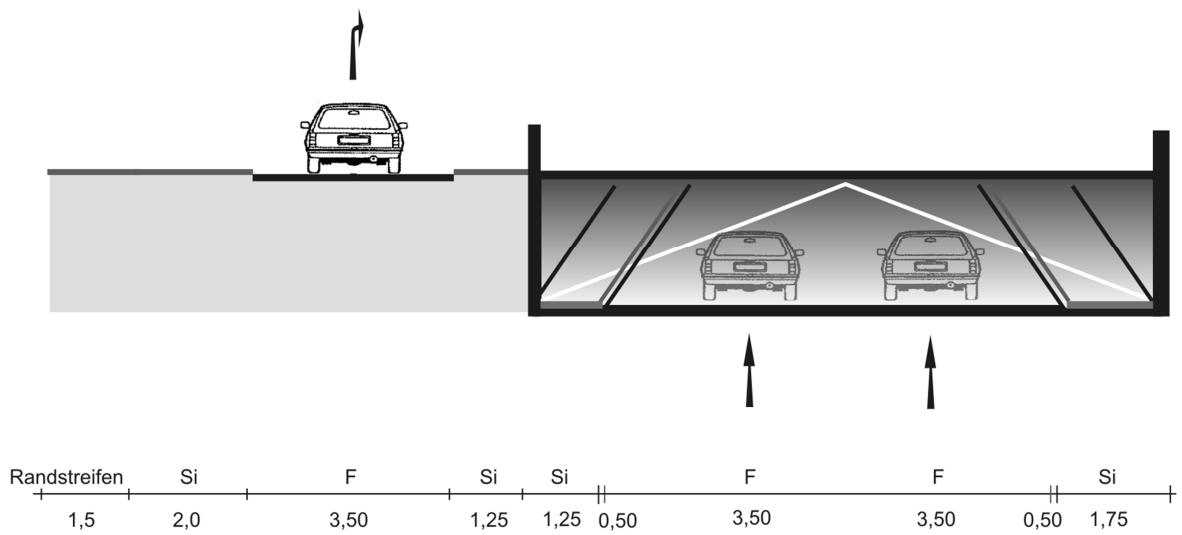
Schnitt Auffahrtrampe parallel A 27
